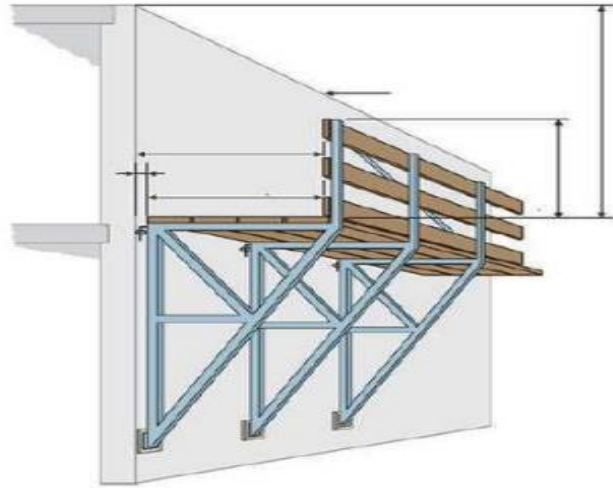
Proteção anti queda em telhado plano. (Guillermo Soto Olea, 2018)
